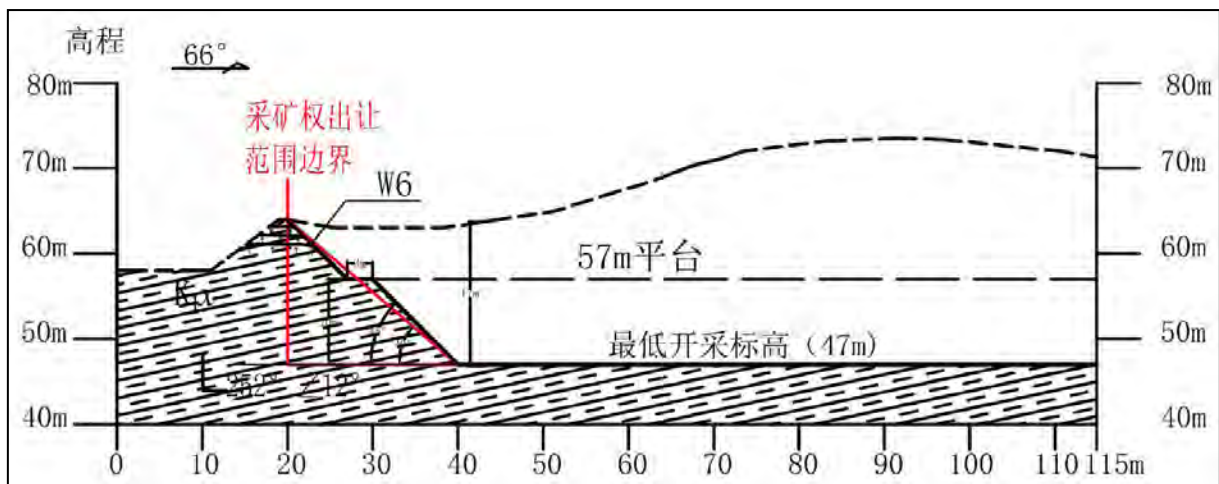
露天采场典型边坡 W6 工程地质剖面图
